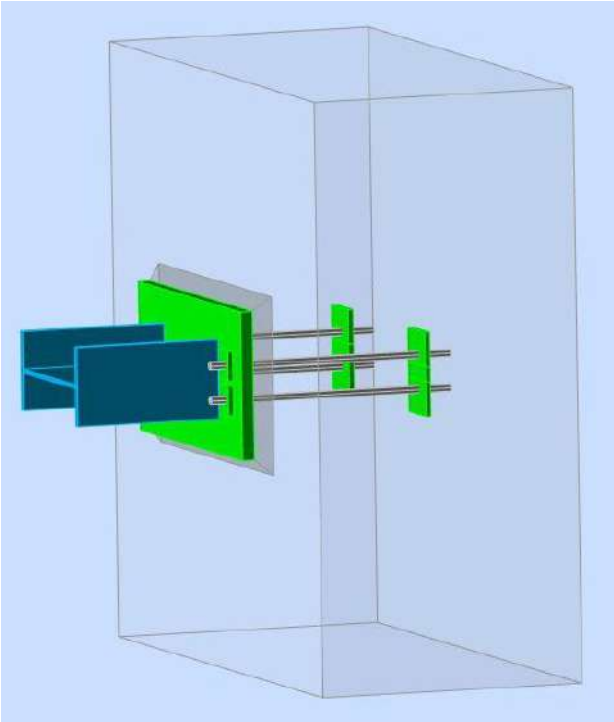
« Vue d’assemblage poutre IPE 330 avec noyau central fait par Robot »
